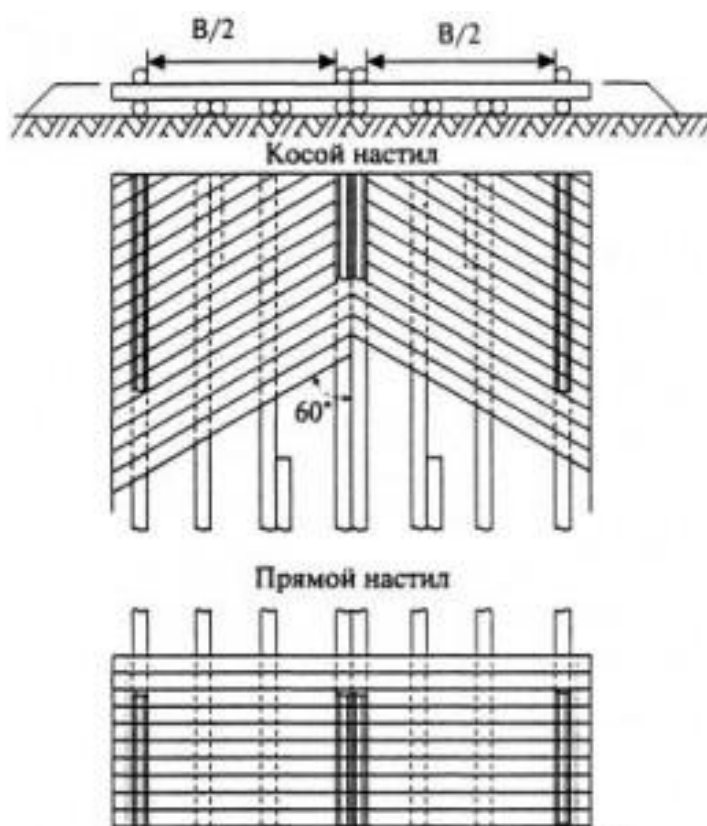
Конструкция покрытия со сплошным бревенчатым настилом:
